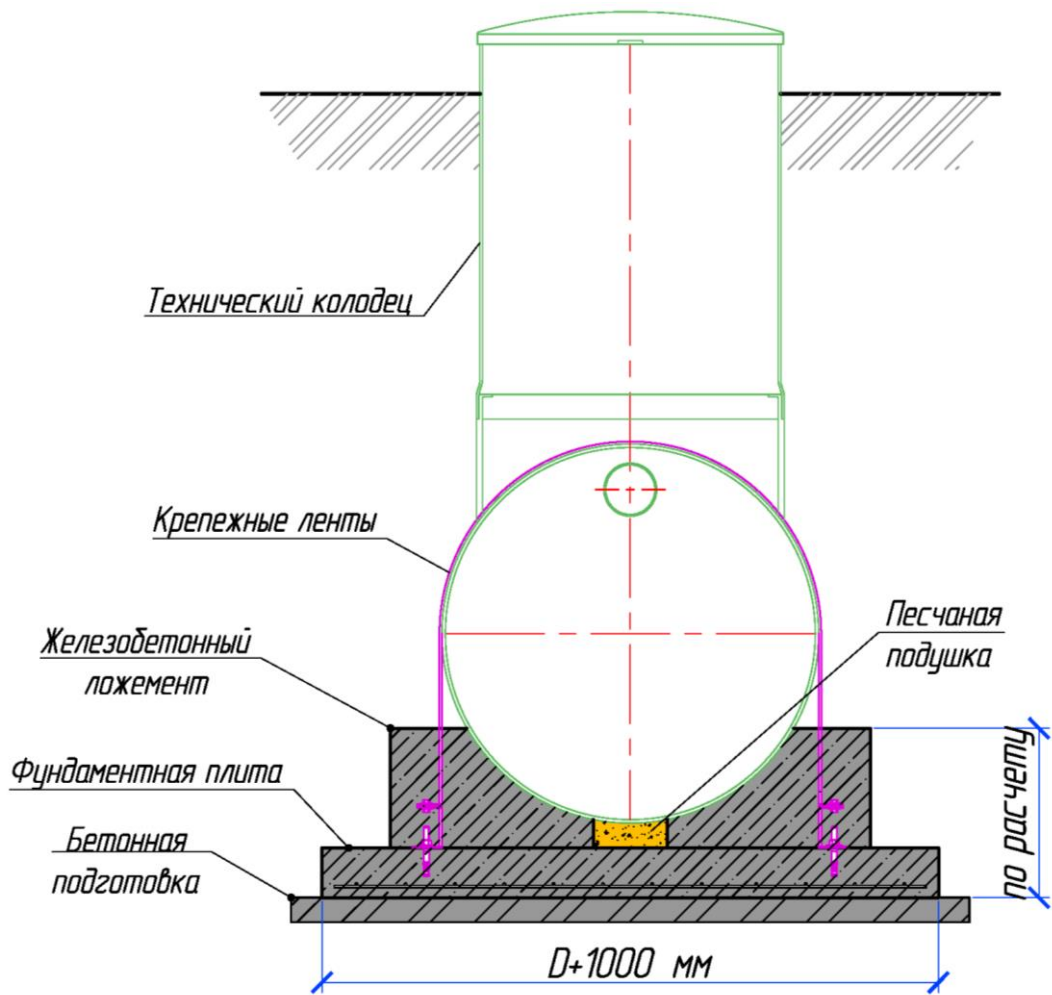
Крепление горизонтального изделия к фундаментной ж/б плите
